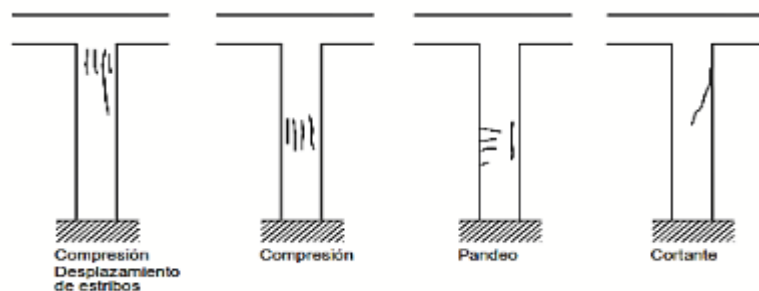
Tipo de Fisuras de Compresión en las columnas
